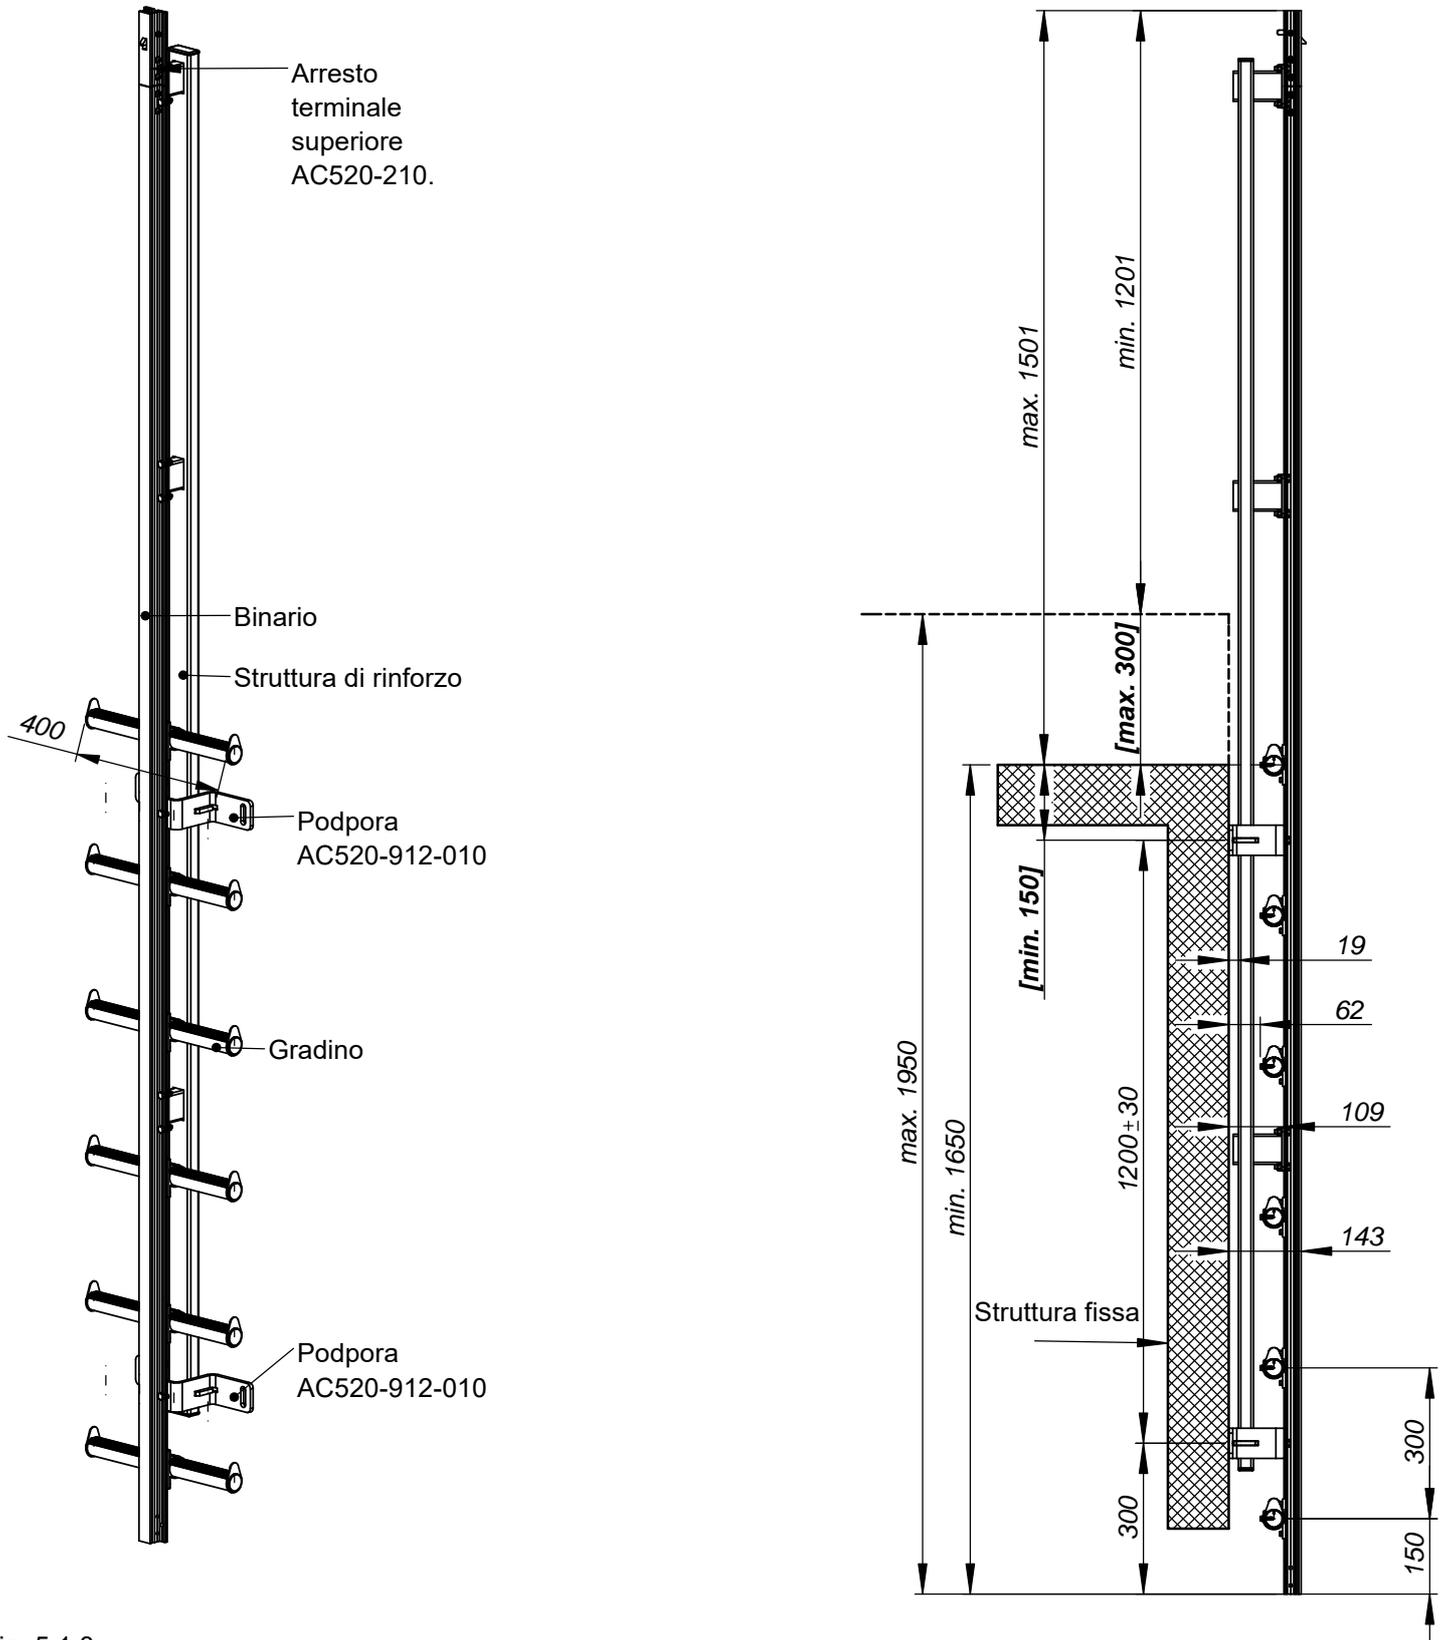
AC520-915-020 Segmento basso della scala - uscita dritta sul tetto (struttura, componenti, dimensioni base).
